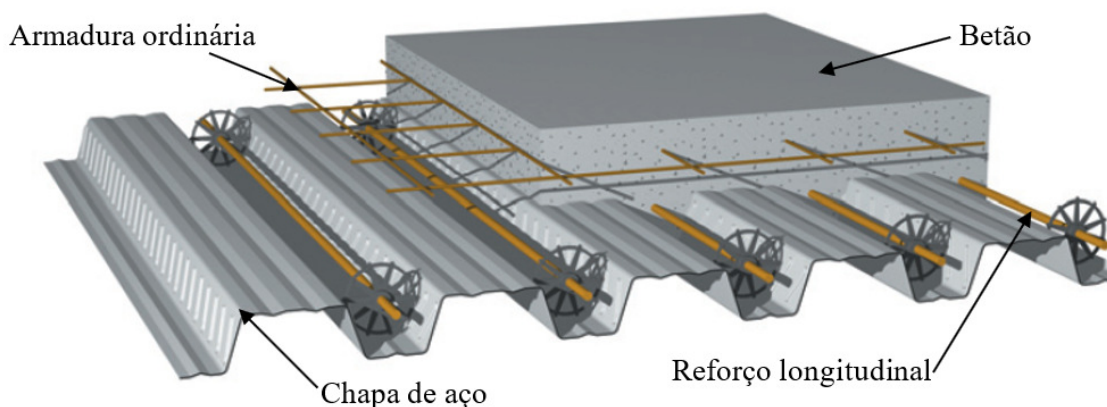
Elementos constituintes de uma laje mista (ArcelorMittal, 2009)
